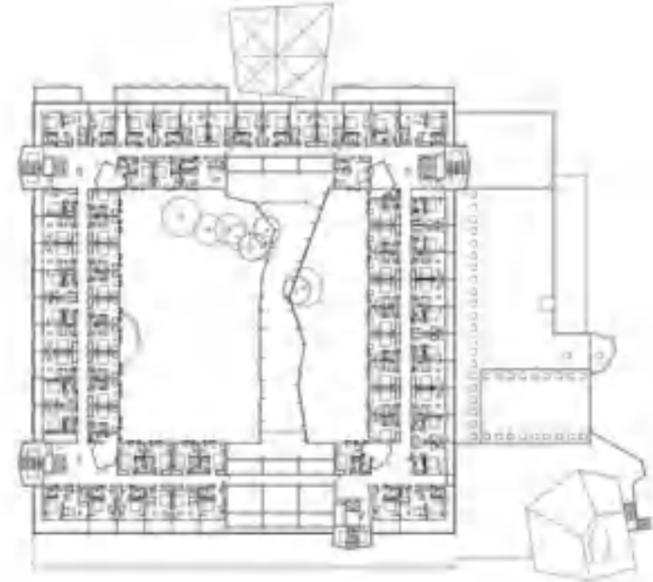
Planta Baixa Pavimento Térreo. FONTE: Archdaily.
